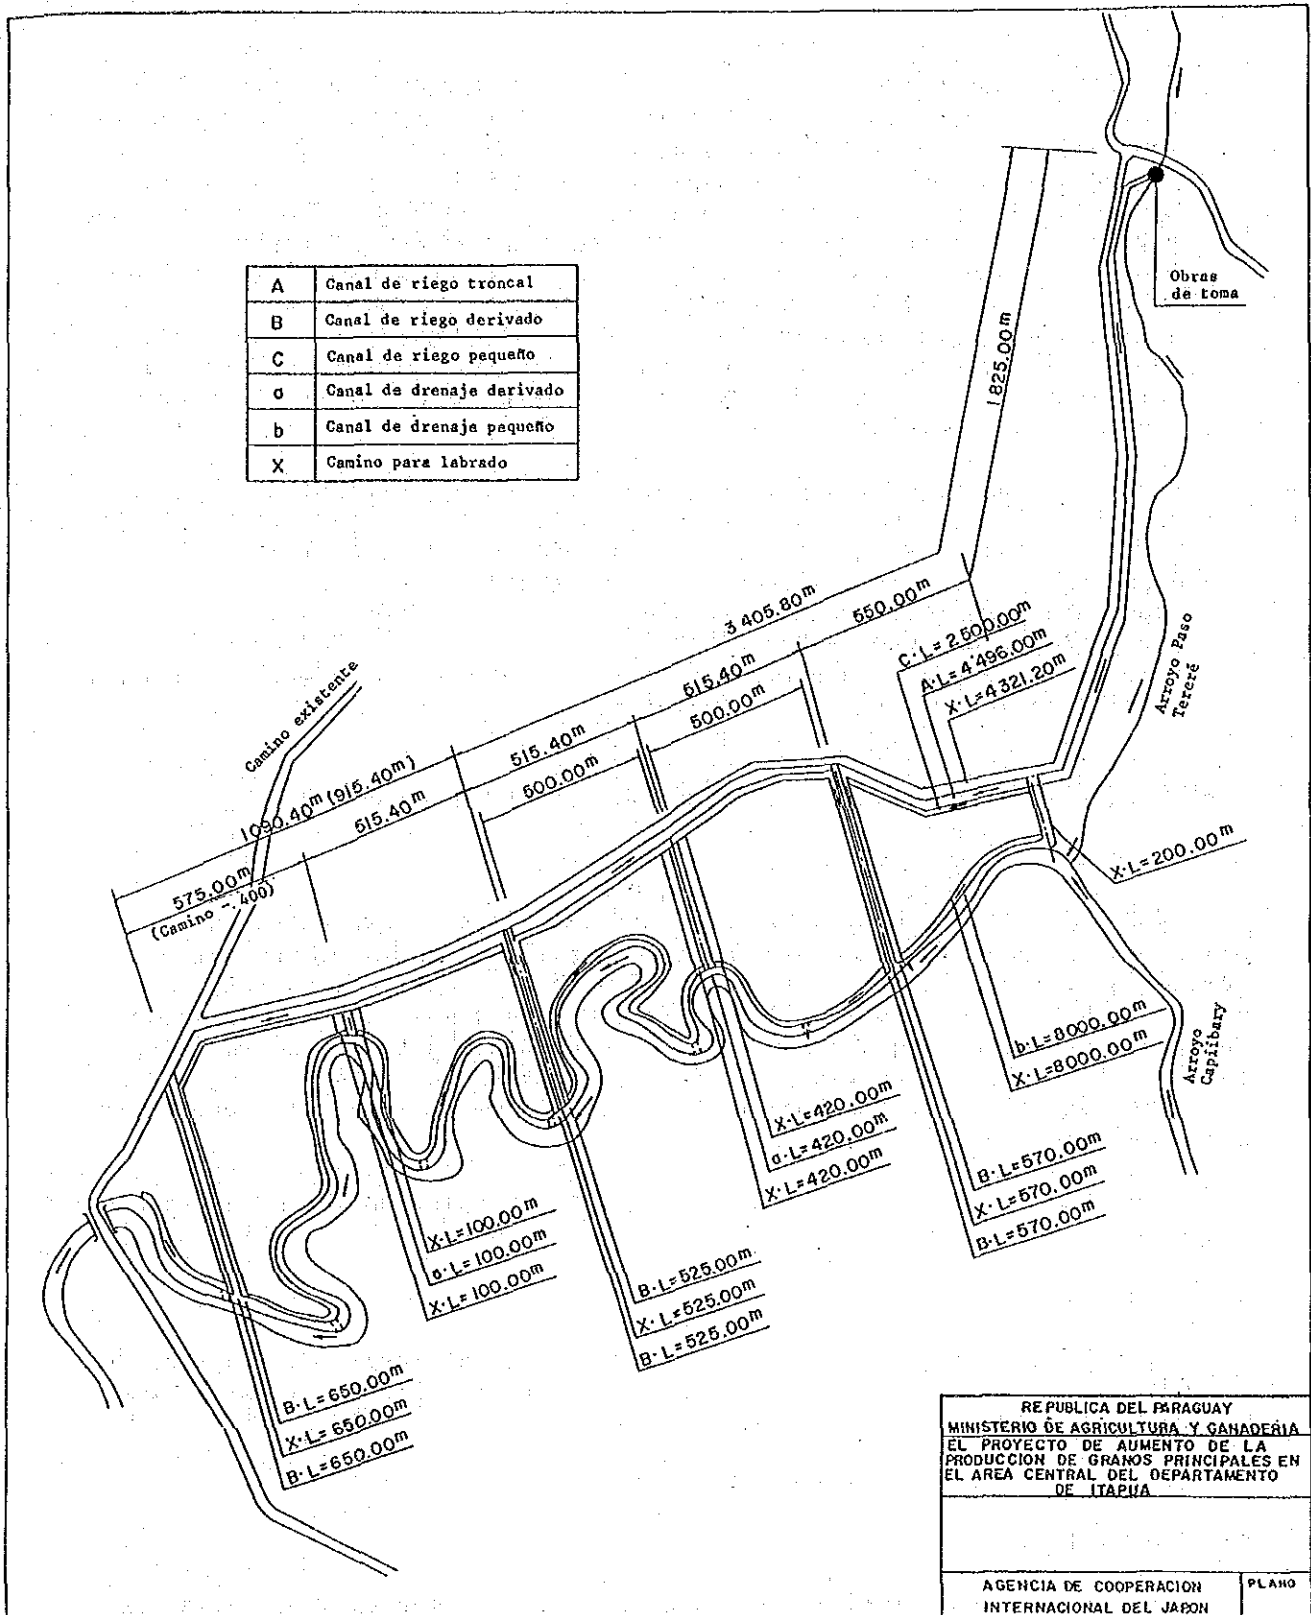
PLANO DE PLANTA DEL PROYECTO DE RIEGO DE LA CUENCA DEL ARROYO TERERE
